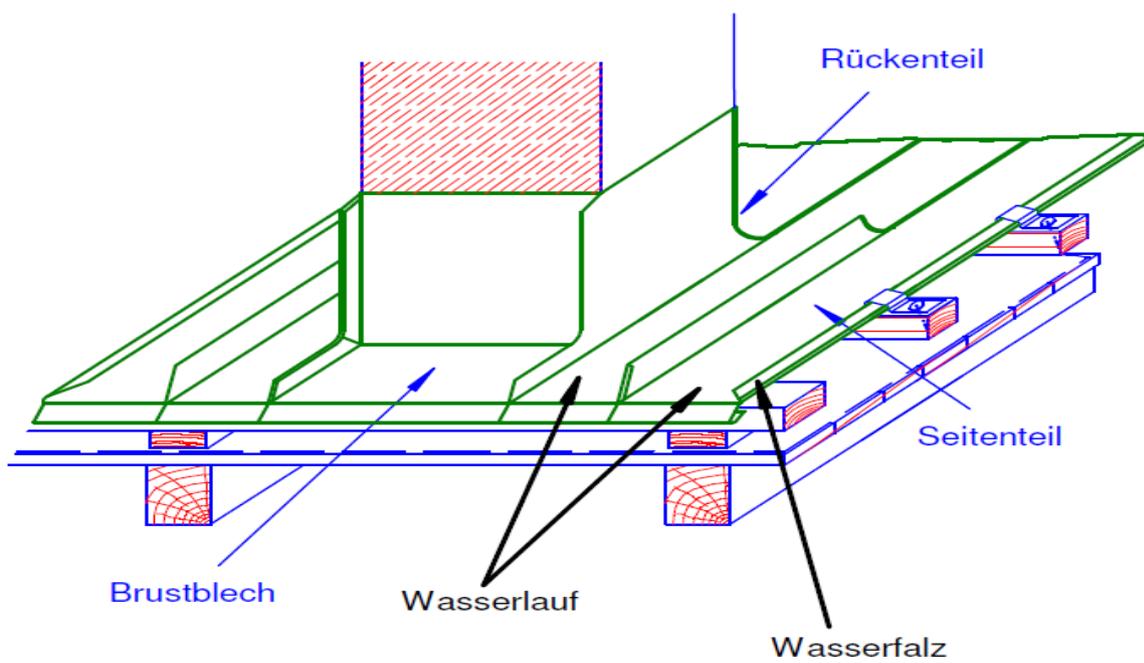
Wandeinfassung; Flachdach- An und Abschlüsse für Wärmedämmverbundsysteme (WDVS-Fassaden), siehe Abschnitt 3.1.98
